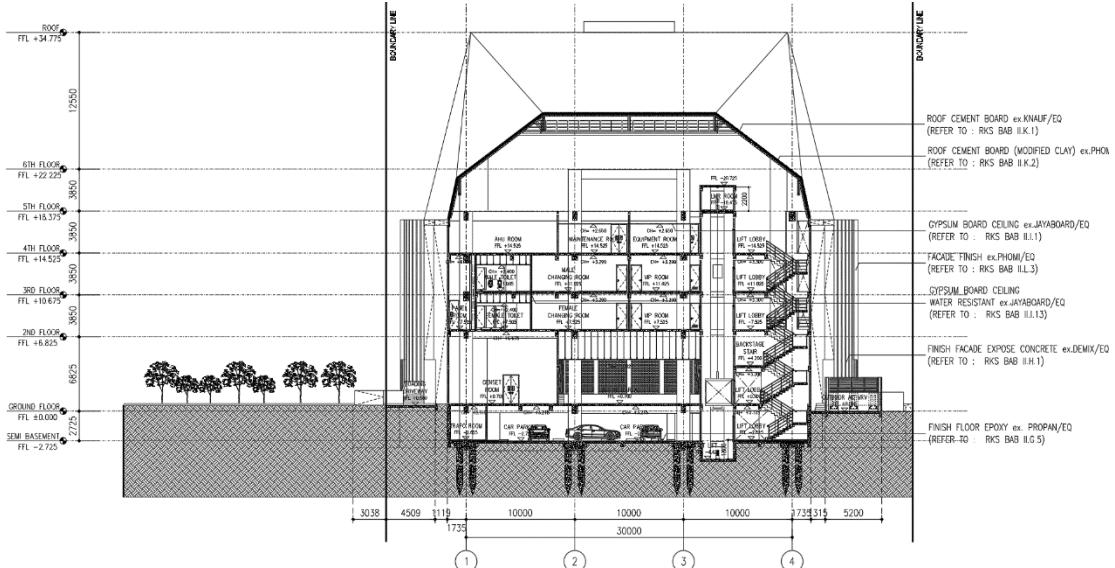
Potongan Bangunan (dari gambar DED *elevation section 2*)
